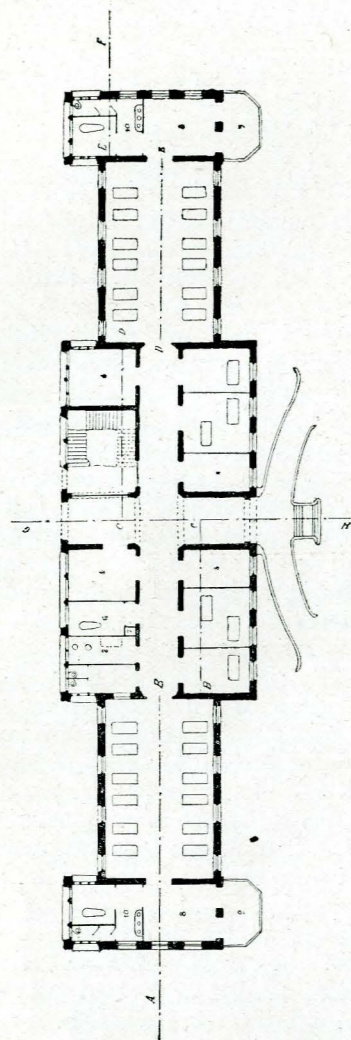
Pianta del piano terreno del Padiglione medico-chirurgico.
